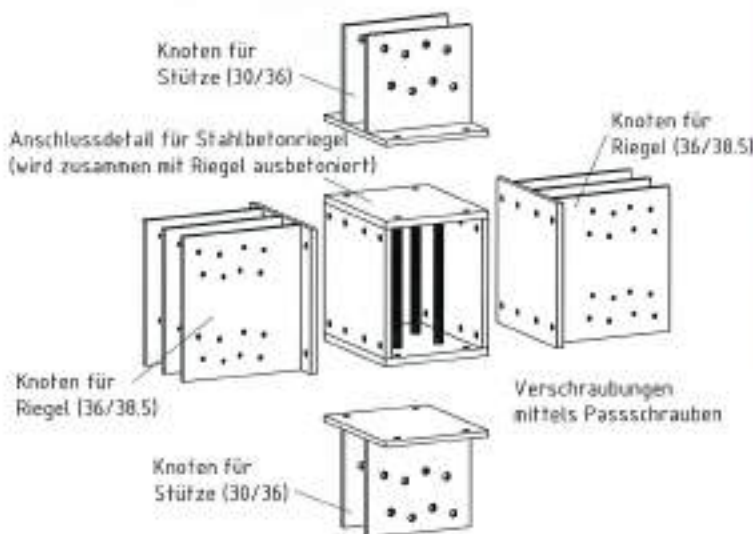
Explosionszeichnung Anschluss Stahlbetonunterzug
